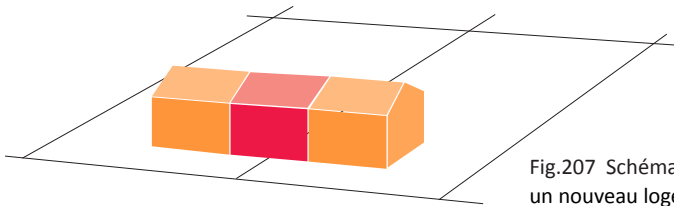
Schéma du principe « Construire un nouveau logement à l'alignement »
